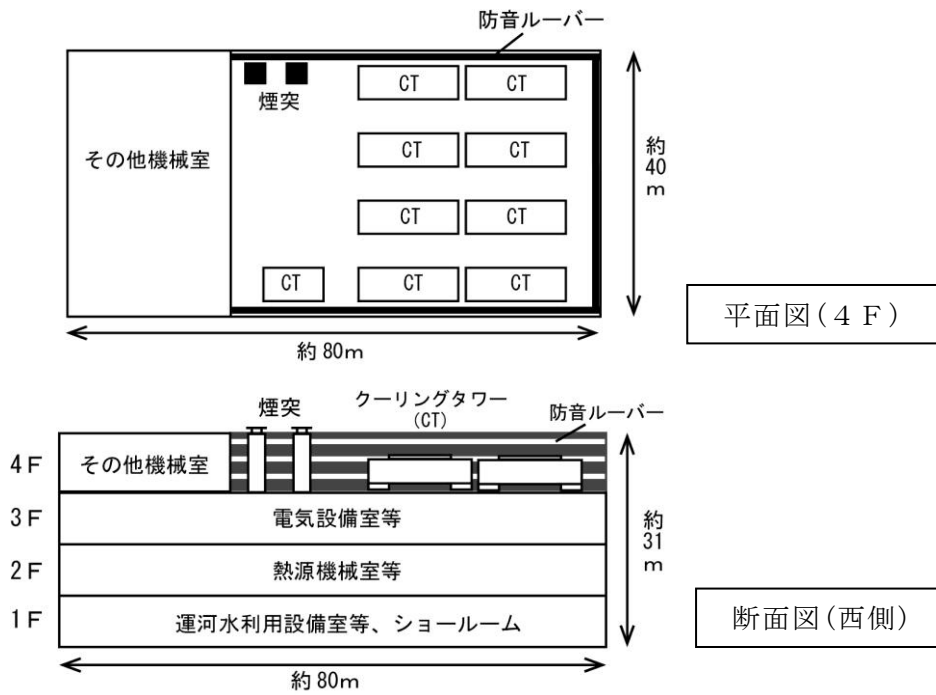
(1) エネルギー施設Aの平面図及び断面図 (変更前)
